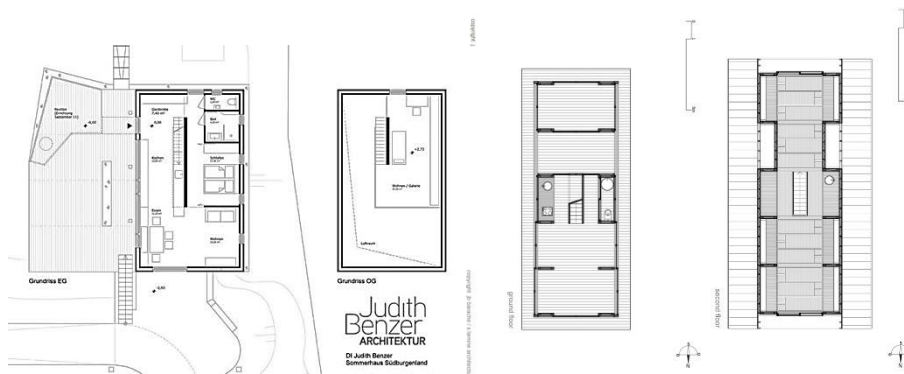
Casa de Verão em Southern Burgenland - Judith Benzer Architektur (<http://europaconcorsi.com/projects/200223-Summer-House-in-Southern-Burgenland>); Fig. 294 - A House in the Fields - Jean Baptiste Barache, Sihem Lamine, Barache/Lamine Architects (<http://europaconcorsi.com/projects/91828-A-House-in-the-Fields>).
